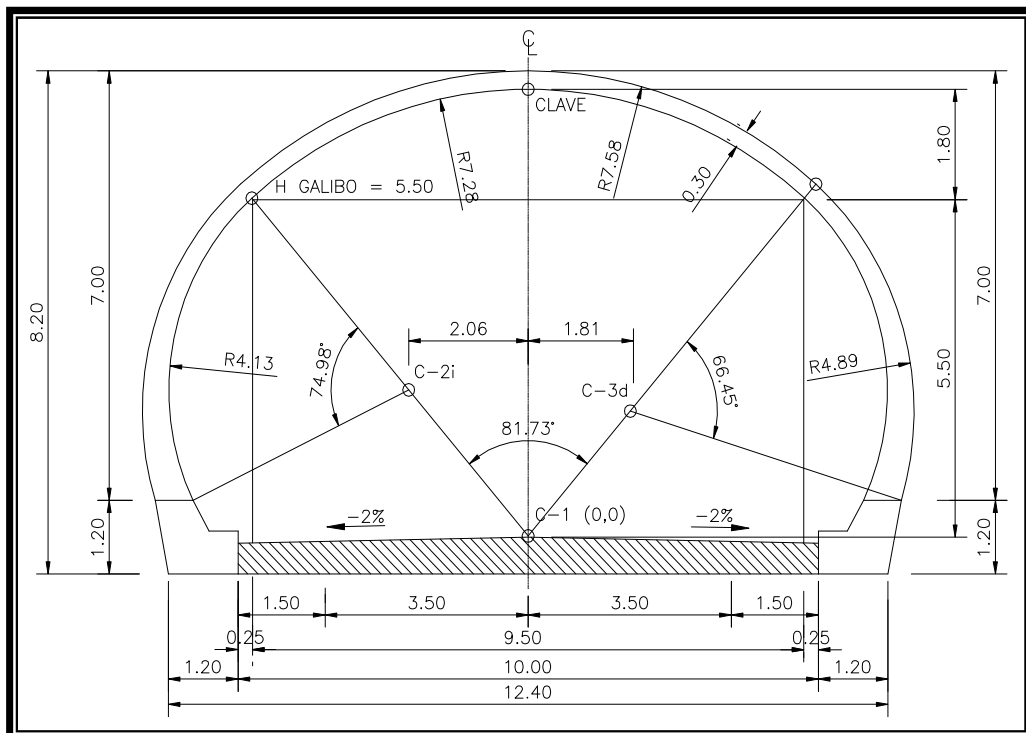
SECCIÓN TIPO PARA TÚNELES.
